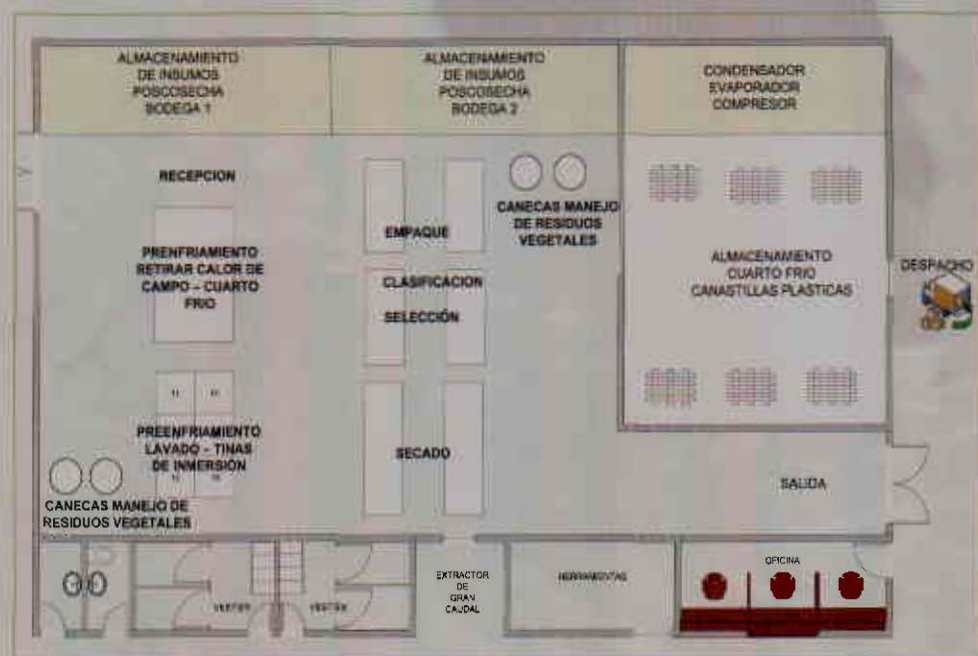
Diseño y planos de la estructura de la planta poscosecha
